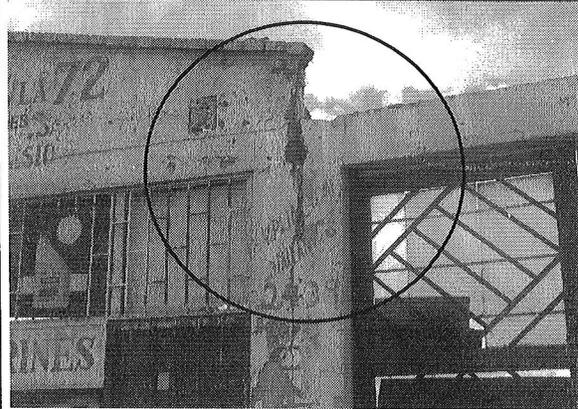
Grietas en la parte superior del muro del costado norte.
